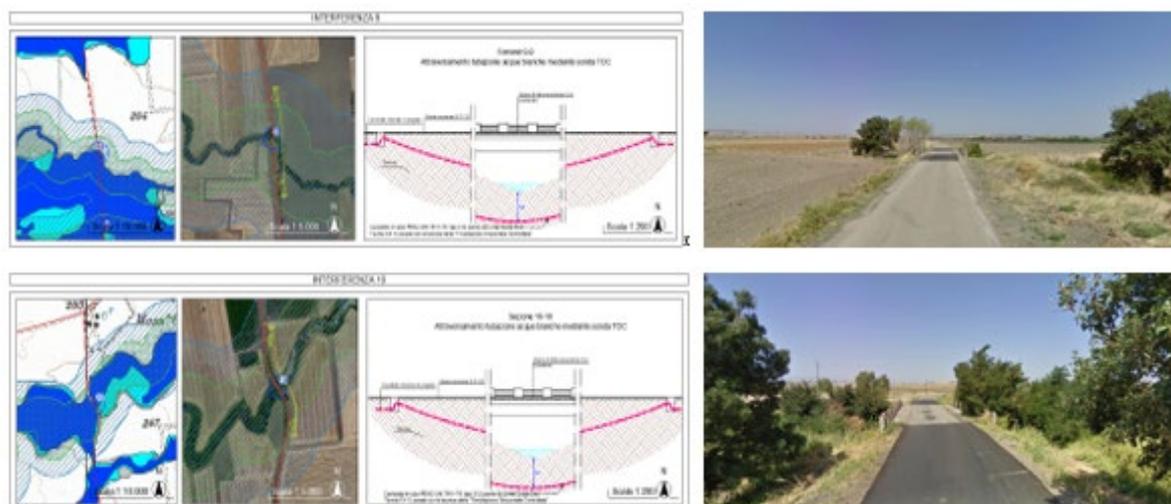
Stralcio studio degli attraversamenti – Stralcio studio degli attraversamenti – “Torrente La Vella di Orsara” - “Torrente” Sannoro” BOV-CIV-TAV-017 – Studio degli attraversamenti
